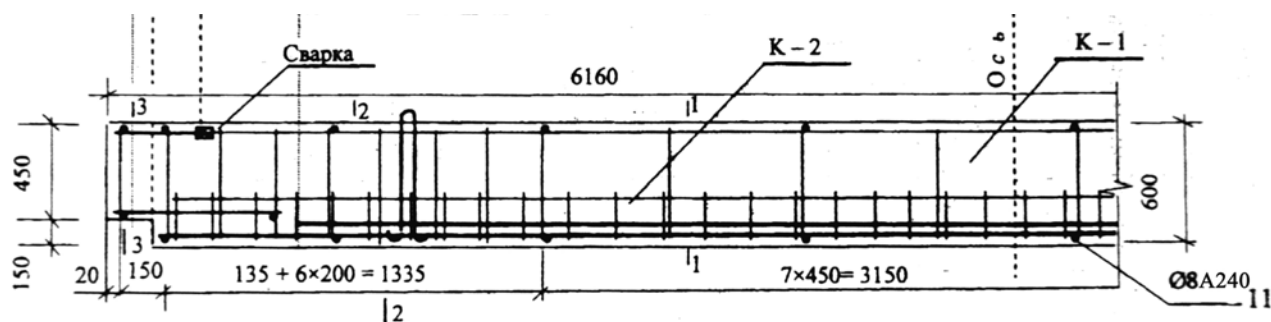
К расчету ригеля: схема армирования ригеля
